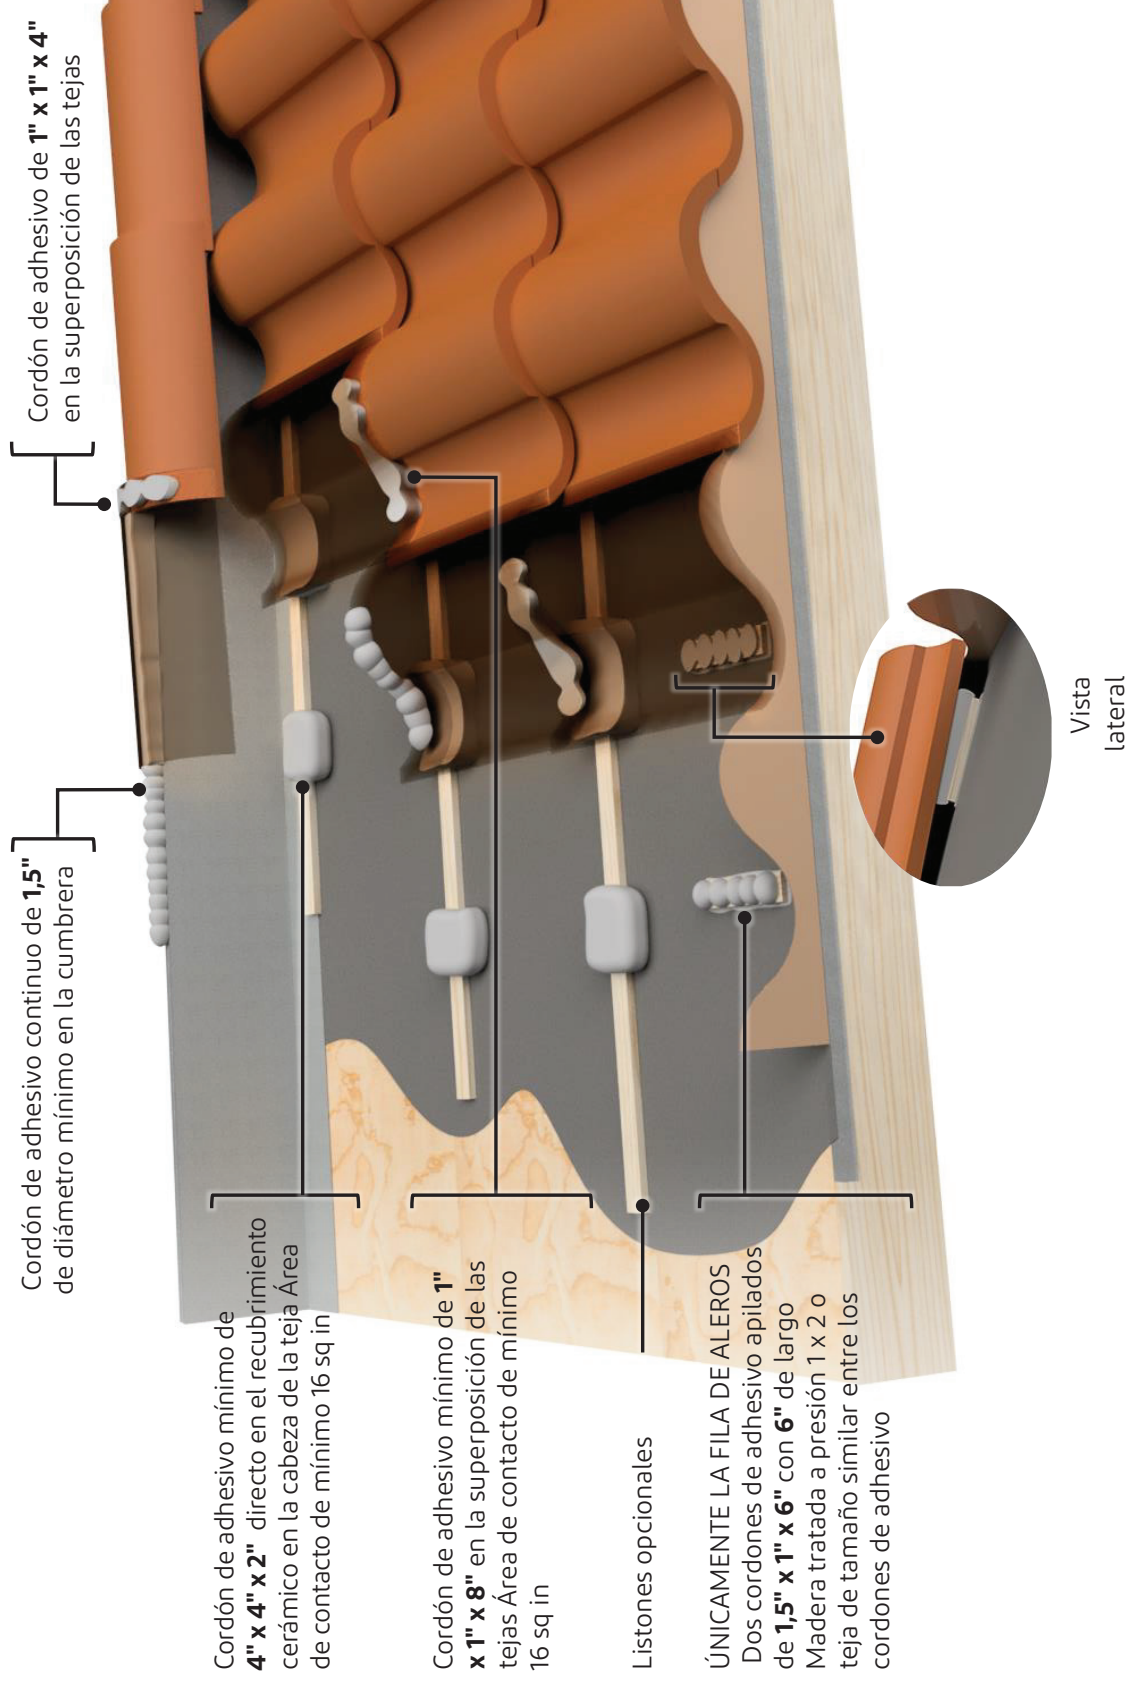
Colocación de adhesivo INDEPENDIENTE de perfil alto
